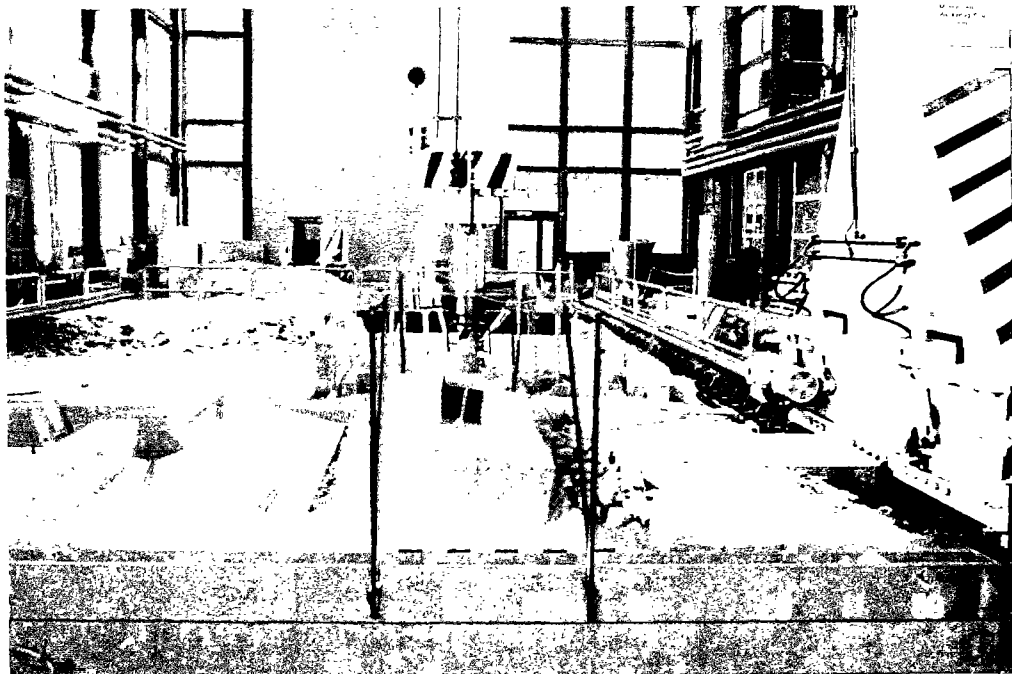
Vue de la fondation et la dalle de transition après la rupture
